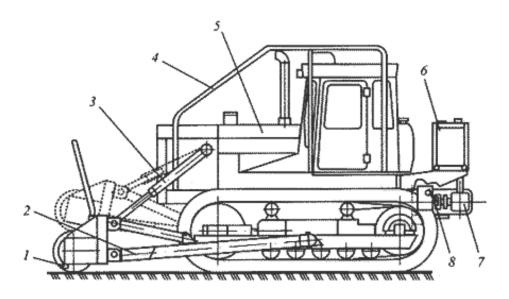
Кусторез с фрезерным рабочим органом 1 - ротор - измельчитель в кожухе; 2 - толкающие брусья; 3 - гидроцилиндры подъема / опускания ротора; 4 - защитная конструкция FOPS; 5 - базовая машина; б - гидросистема; 7 - насос; 8 –ходоуменьшитель.
